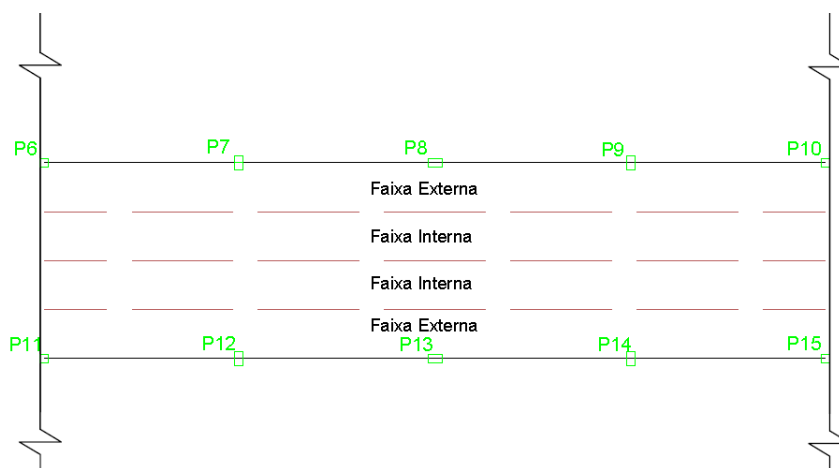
Modelagem do Pórtico 4 e 7, sistema Bubbledeck
